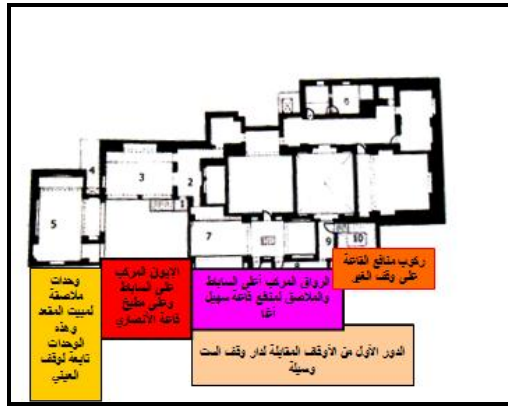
مسقط أفقي يبين إضافات الخوفا عبد الحق الكناني بالدور الأول، عمل الباحث.
